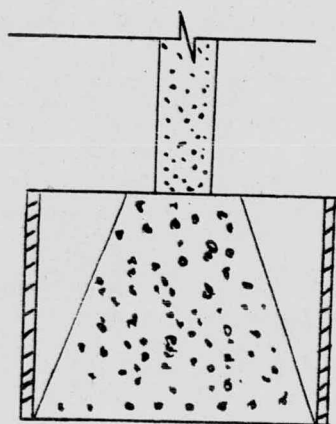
PROTECCION DE LA CIMENTACION.
